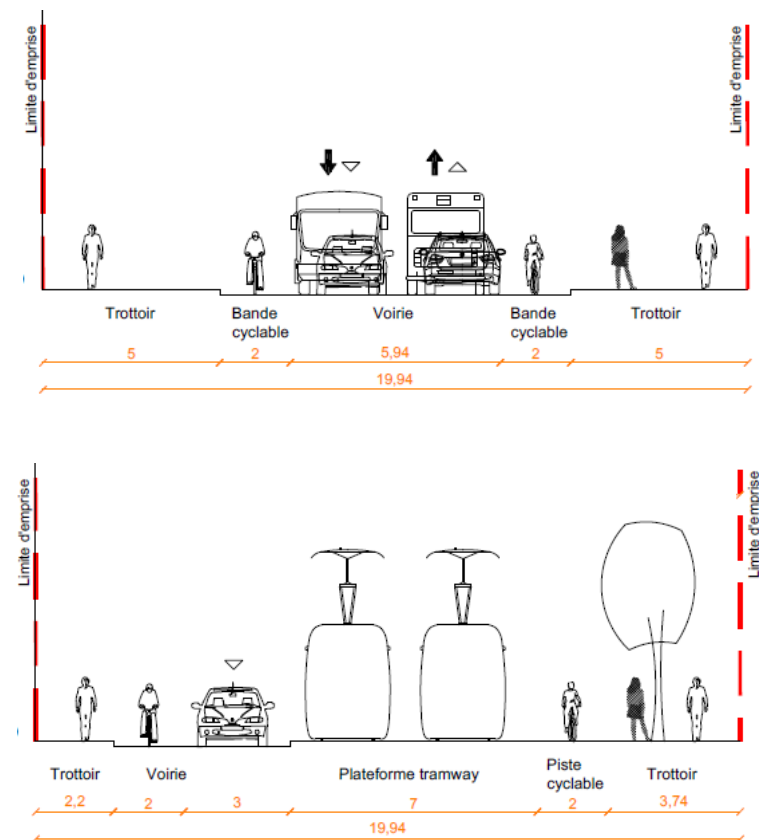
Coupe existant et projet du boulevard des Frères Vigouroux
